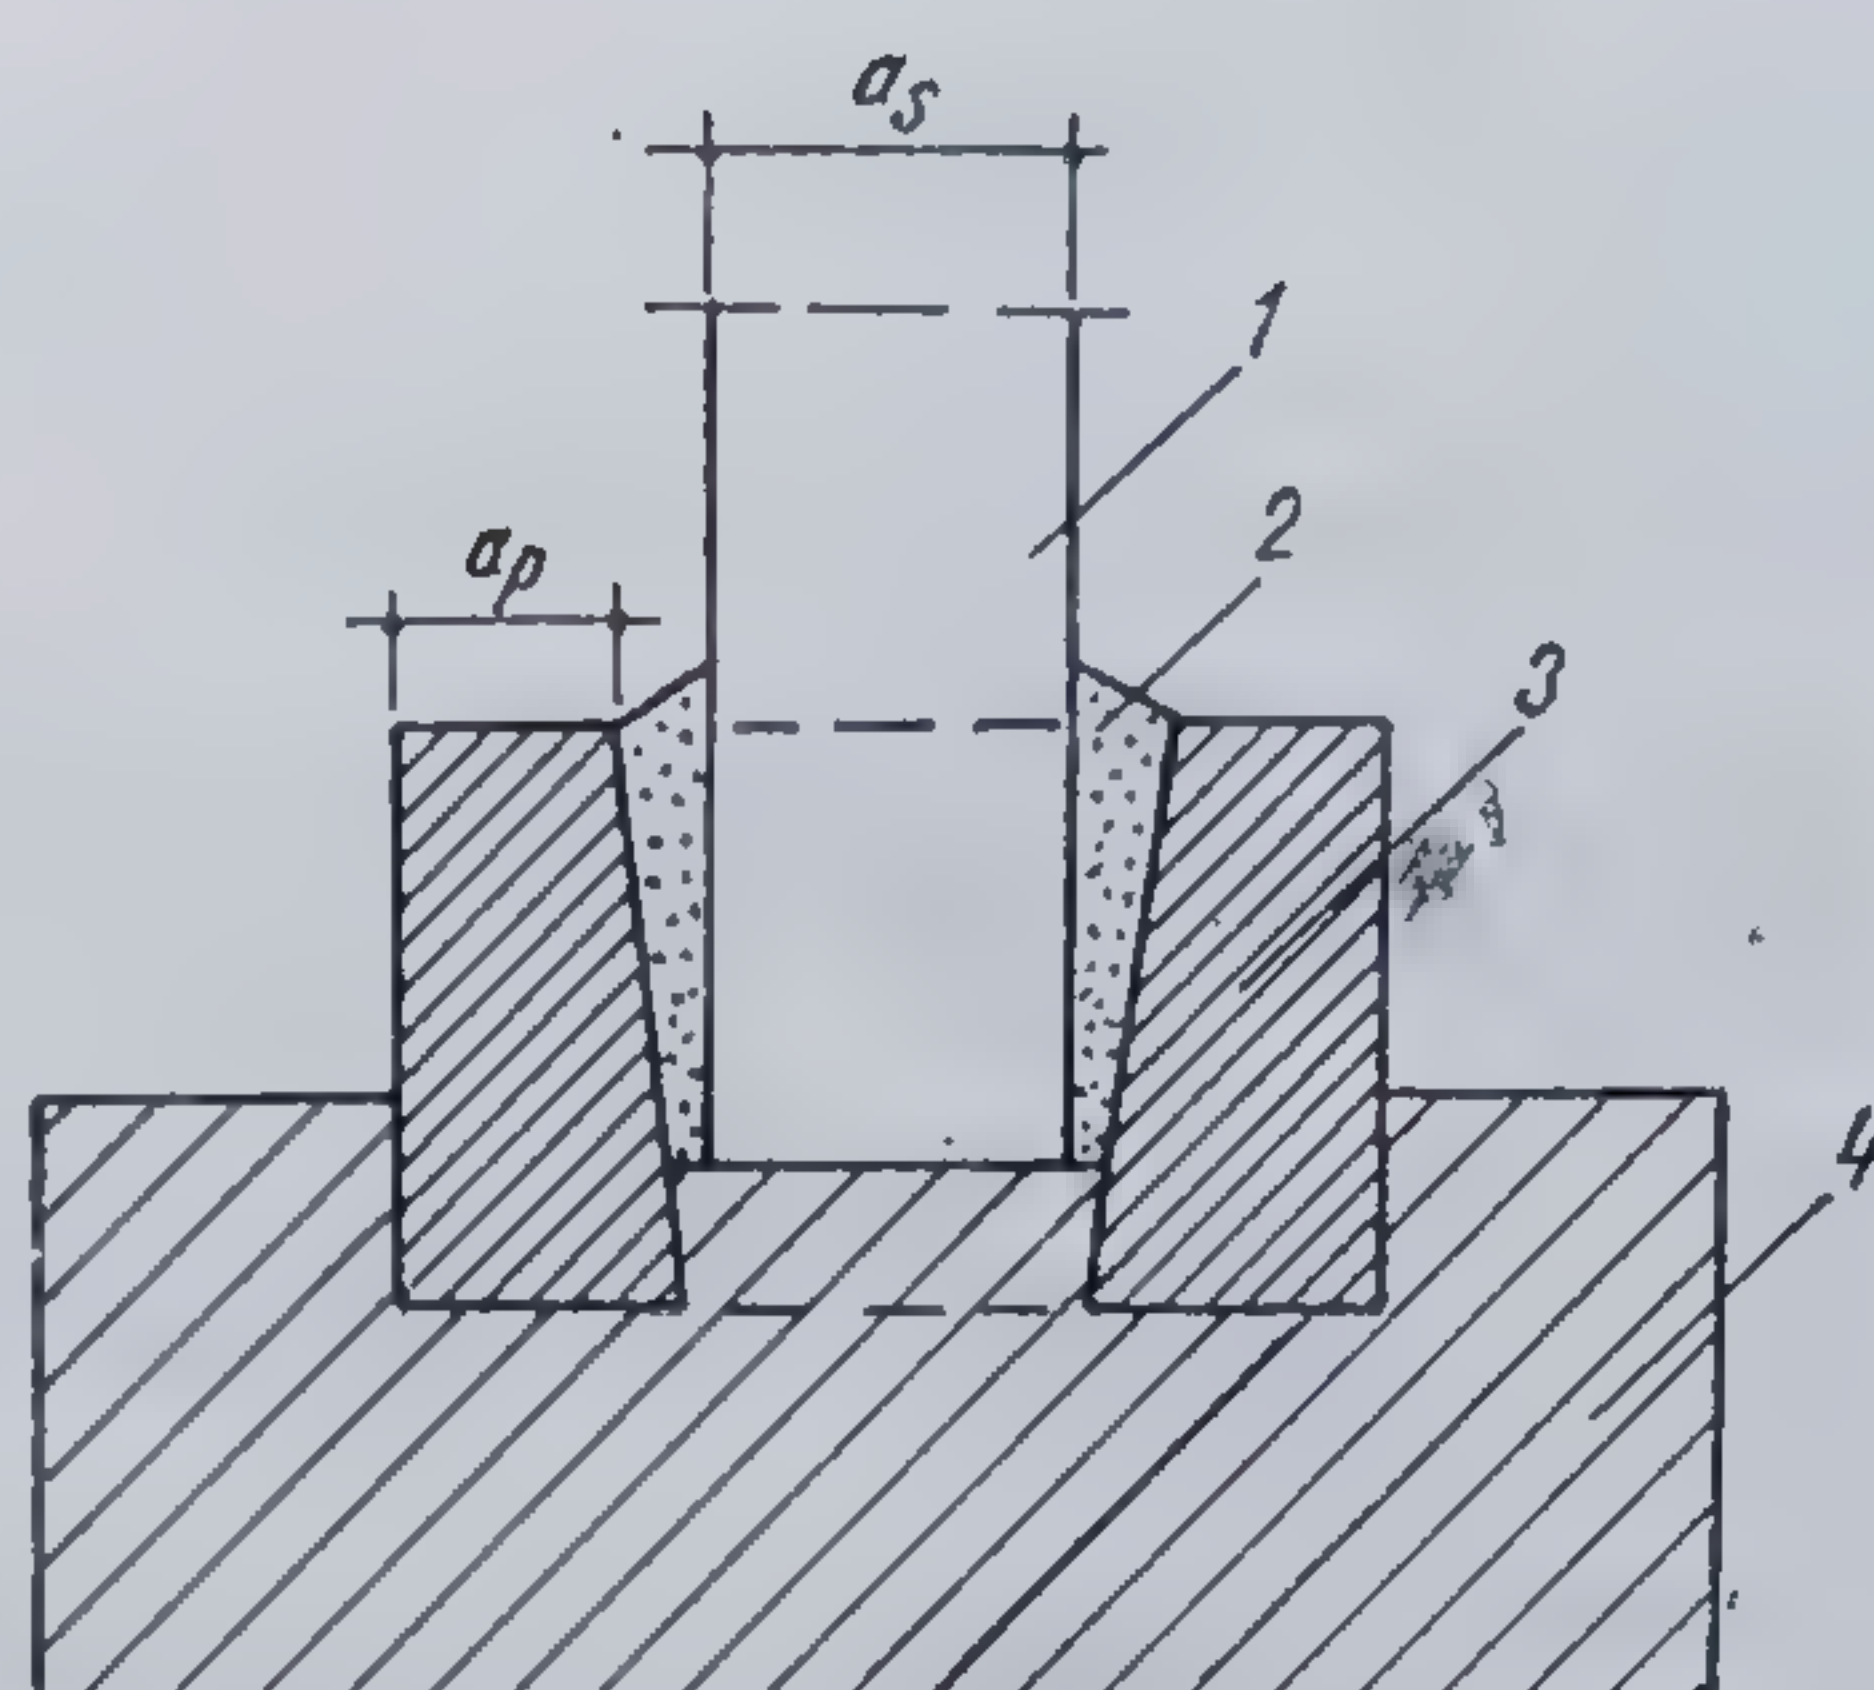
Fundație cu guler prefabricat: 1 — stîlp; 2 — beton de monolitizare; 3 — guler prefabricat; 4 — bloc din beton monolit.
